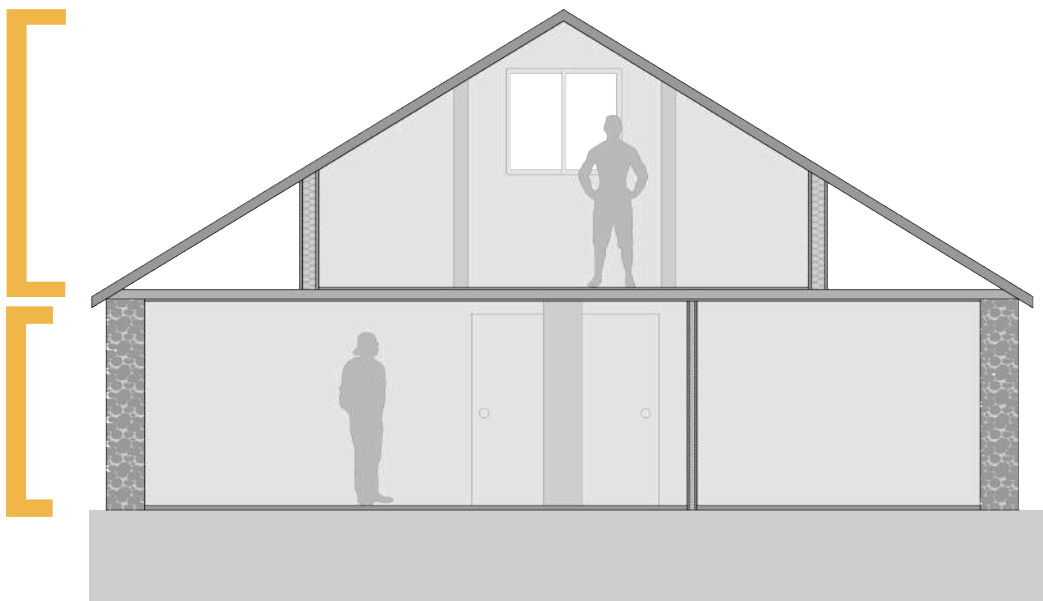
Corte de refugio guardaparques en sector Laguna del Negro Francisco
